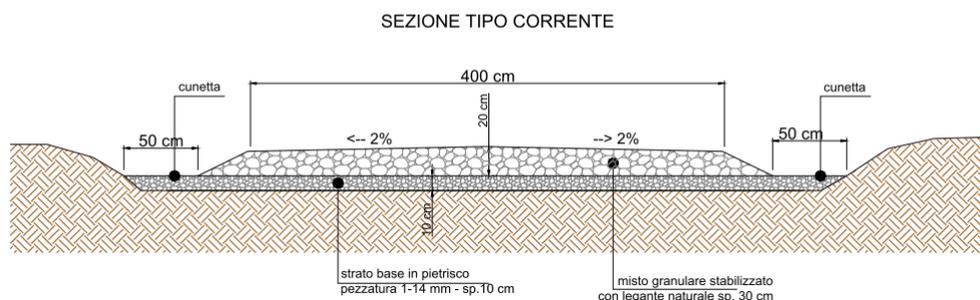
Sezione tipo strada principale di accesso (estratto di PRO\_TAV\_15).
